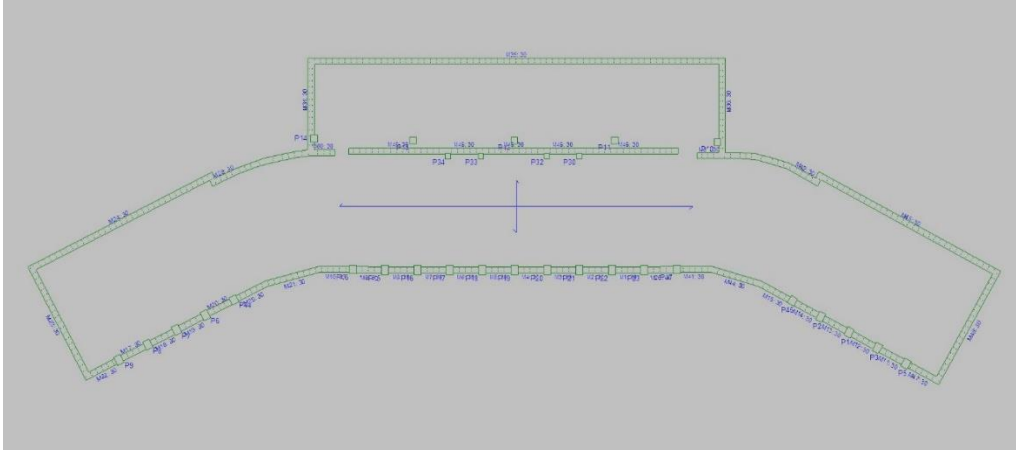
Planta cubierta del modelo de 5 plantas simplificado
